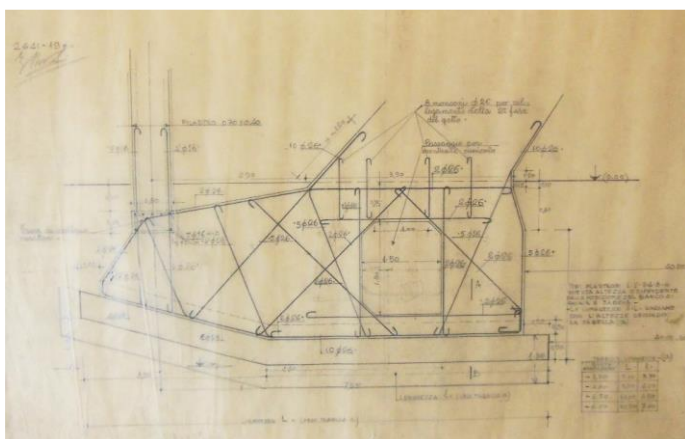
Particolare fondazione pilastro, (Nervi, Tavole padiglione 2, Torino Esposizioni 1947).
